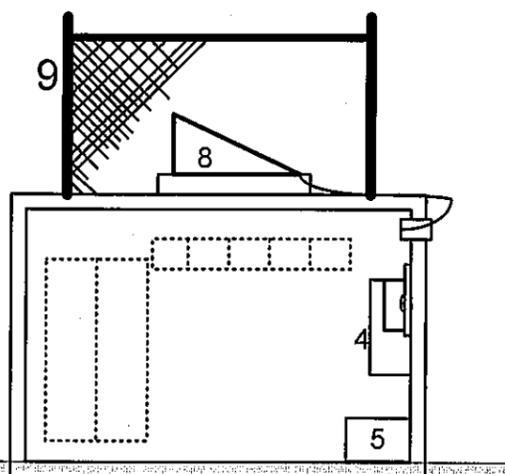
PLAN D'AMENAGEMENT DES EQUIPEMENTS
